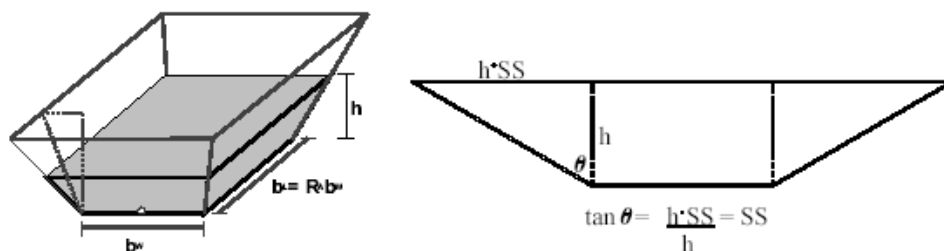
Reservatório com seções transversais e longitudinais trapezoidal
